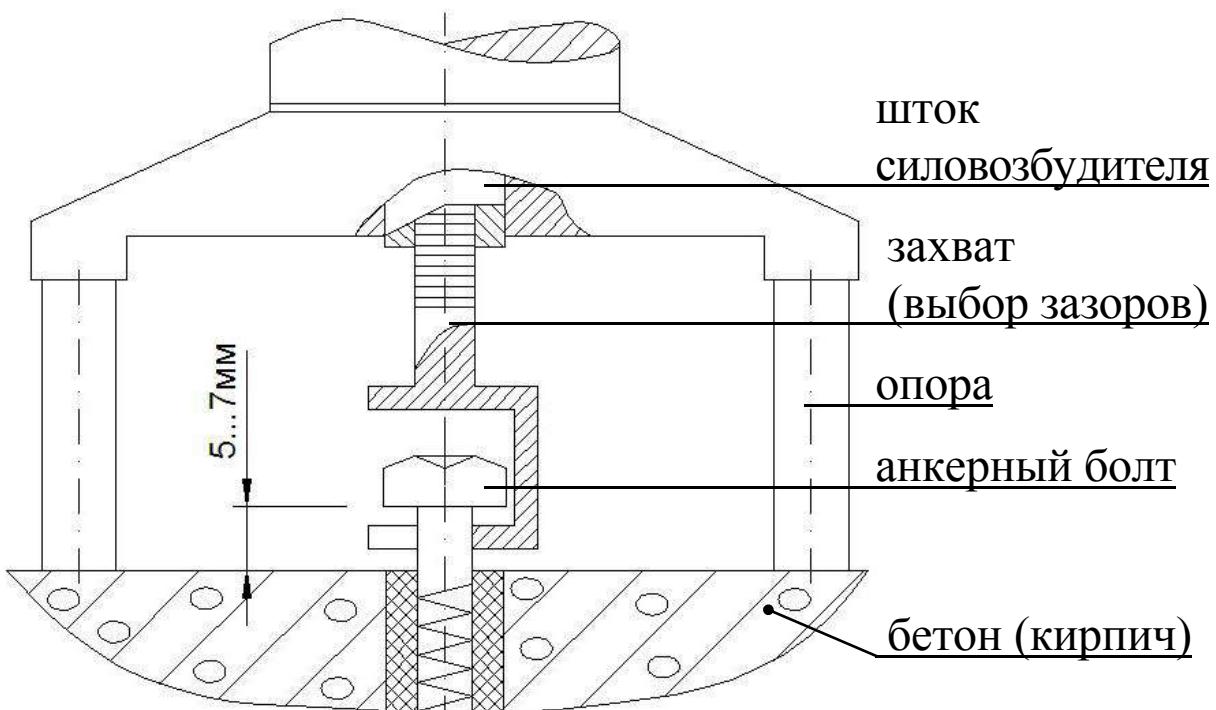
Схема подготовки прибора ПСО-МГ4АД к измерениям
